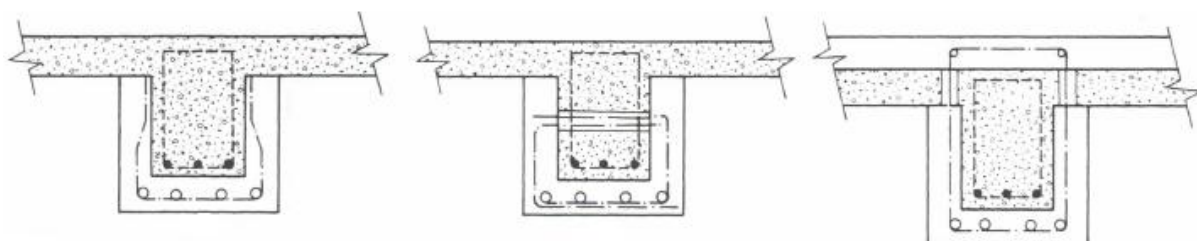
exemplos de reforço de viga com aumento da seção transversal e adição de armaduras longitudinais e transversais
